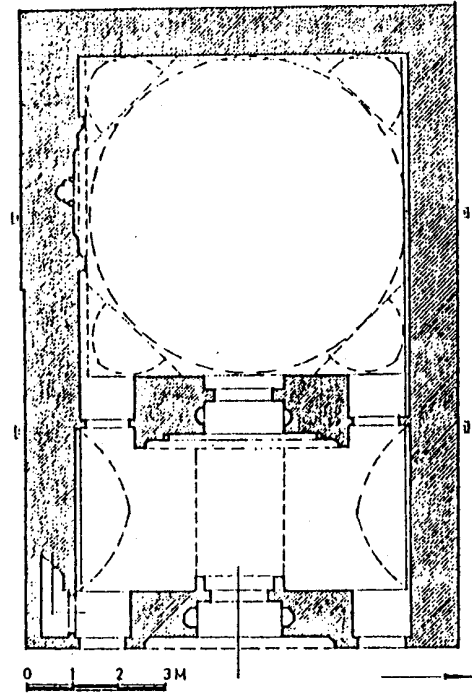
مسقط أفقي لجامع أبو الذهب تجاه الأزهر بالقاهرة (عن لجنة الآثار بالقاهرة)
